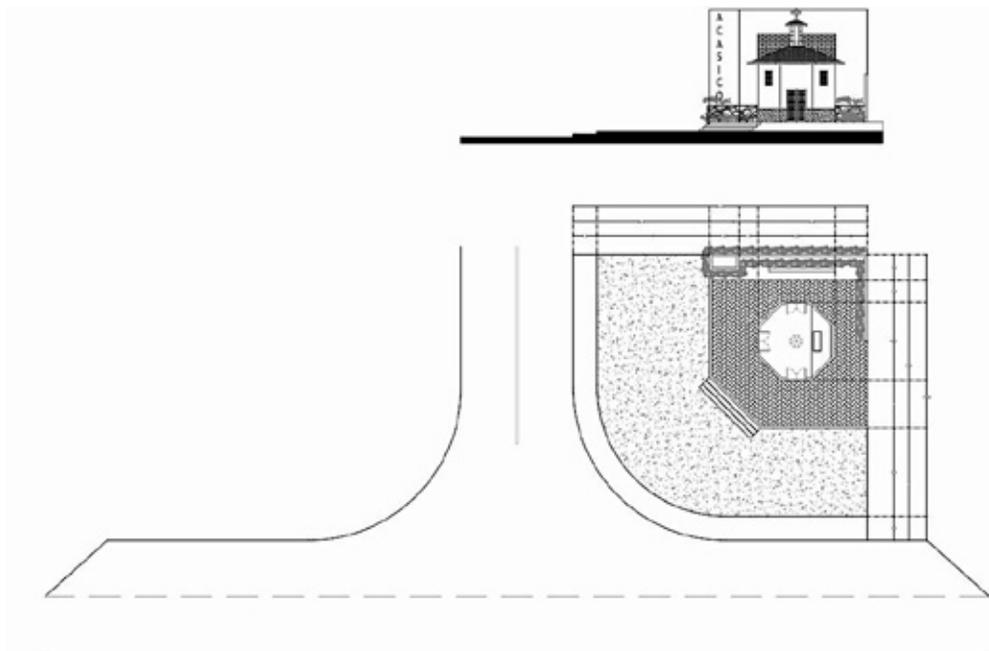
Proyecto arquitectónico de la ermita en la carretera.
